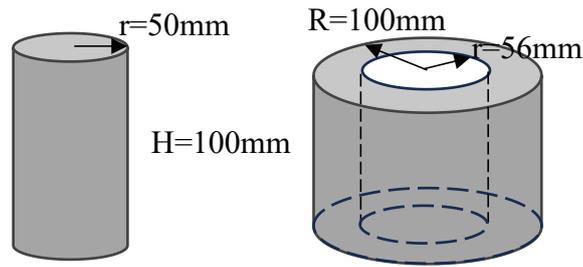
用于混凝土节段预制拼装用结构胶长期剪切性能试验的混凝土试件
